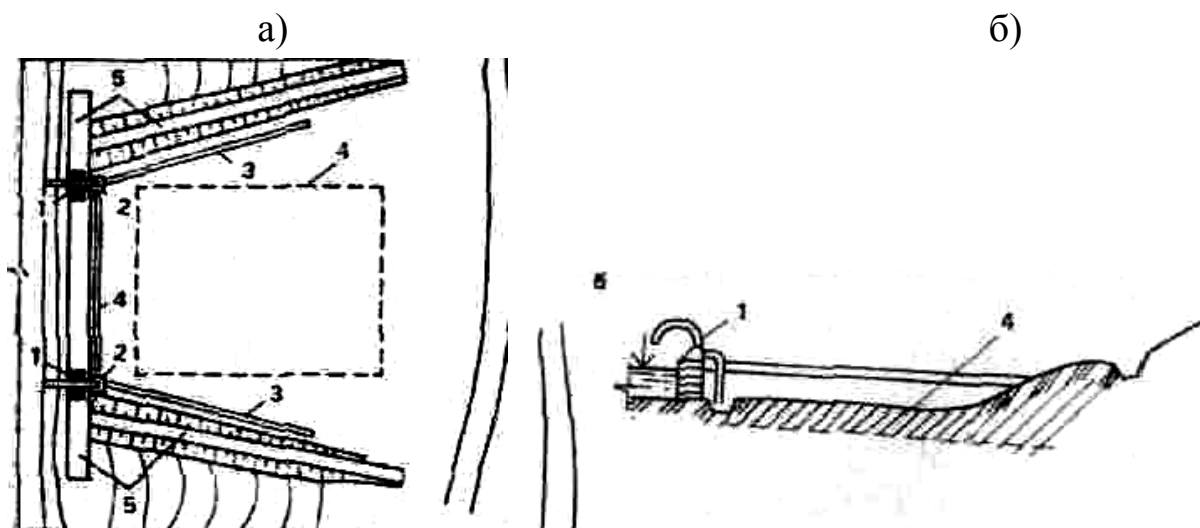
Осушение котлована способом открытого водоотлива (а — план, б — разрез)
